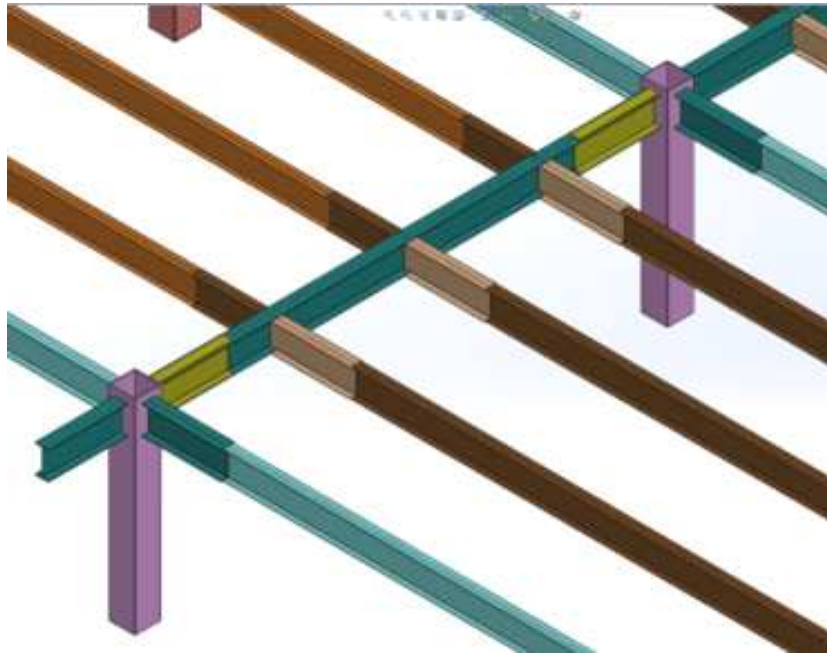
Esquema de las vigas principales y secundarias de la estructura metálica de la Platinum Plaza Club & Condominio
